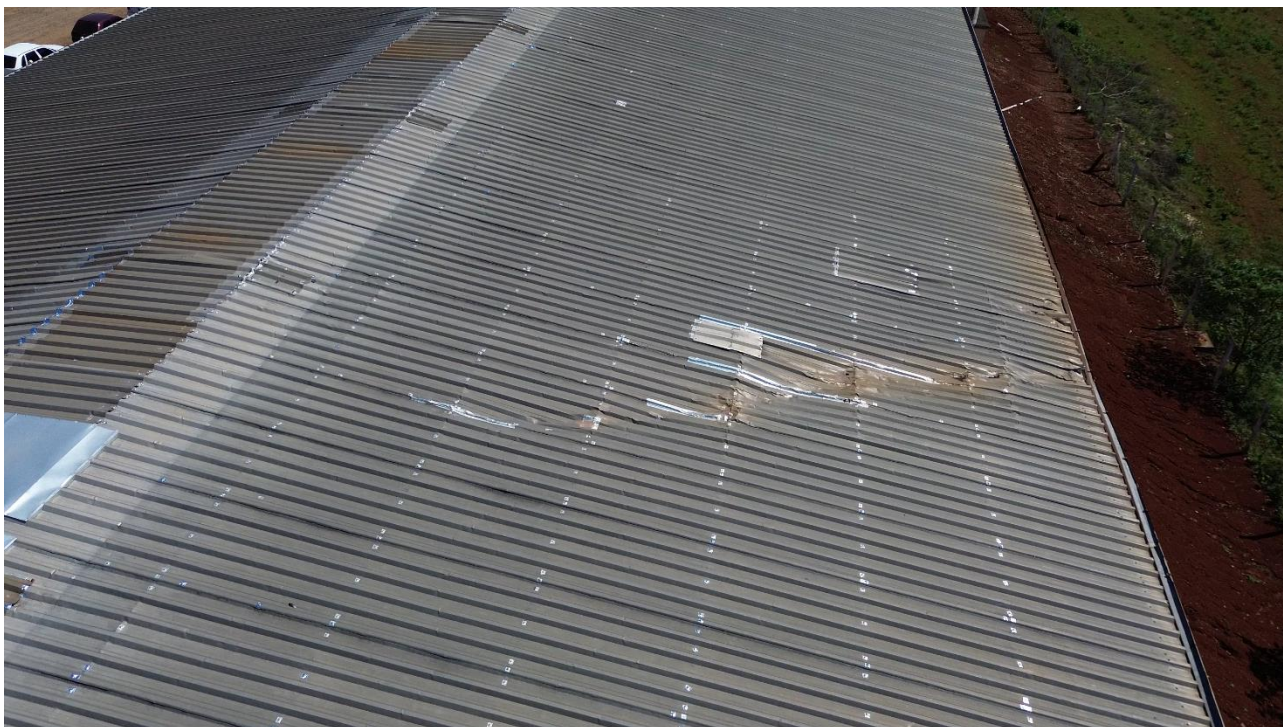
externa – telhas amassadas e furadas na água do fundo – mais ao meio do pavilhão
